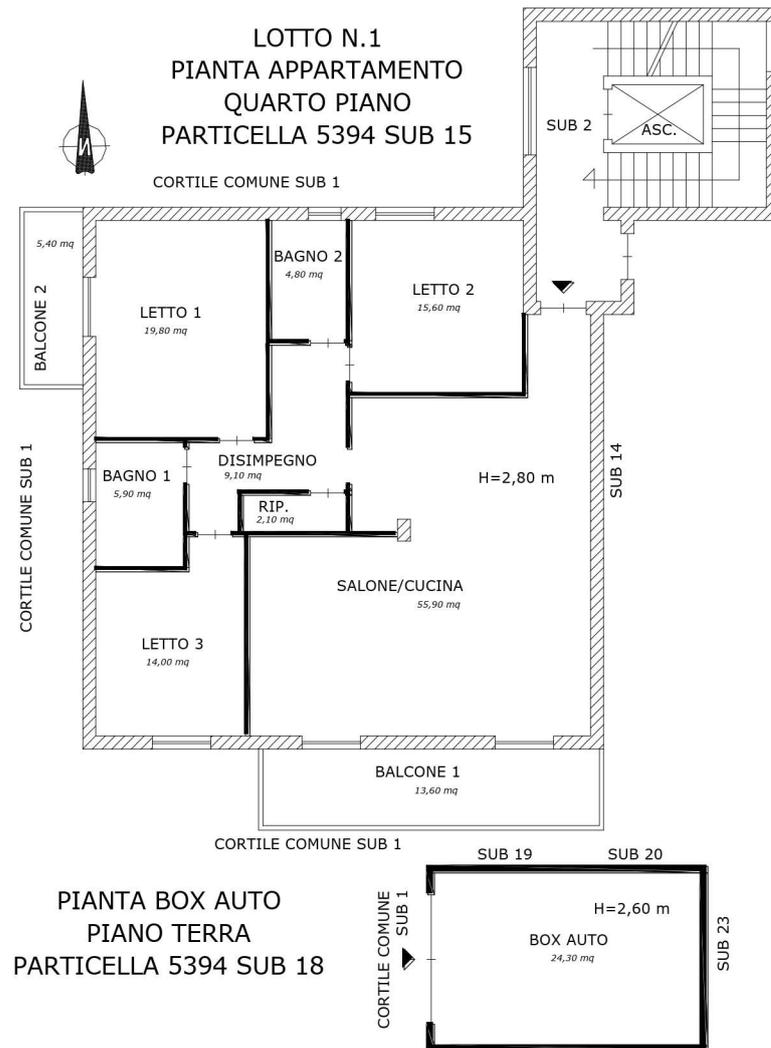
planimetria dell'appartamento al quarto piano e del box auto al piano terra
